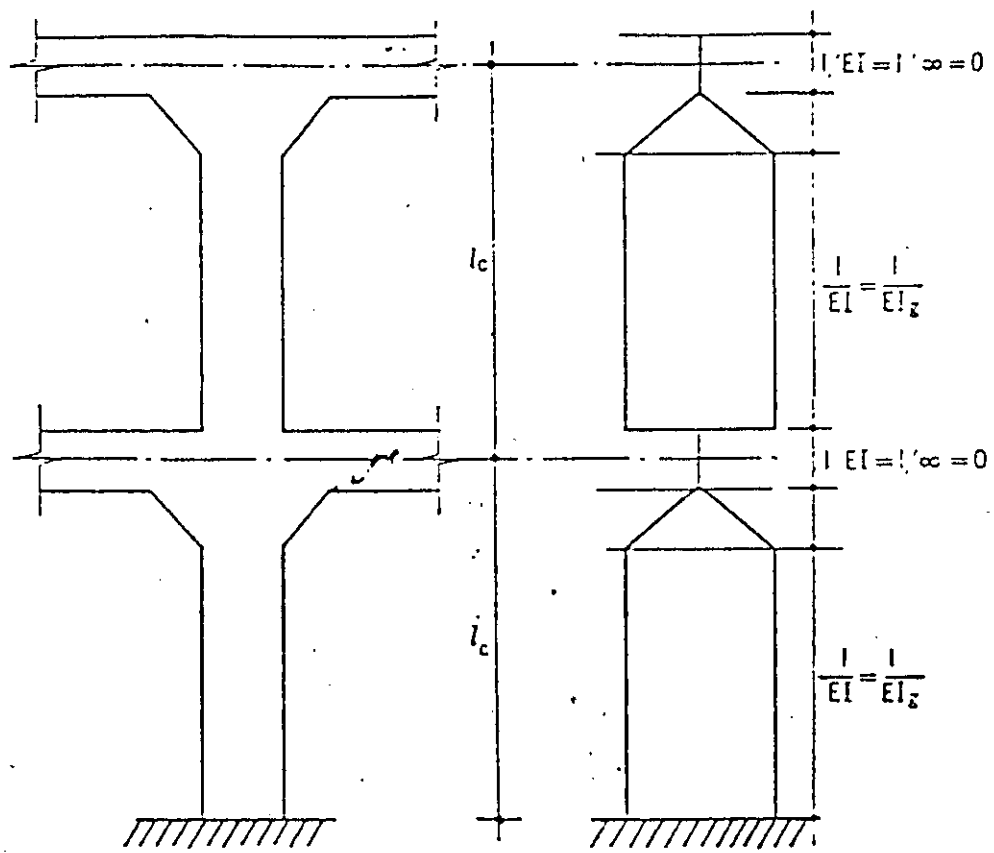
Cálculo de la rigidez de la viga equivalente en sistemas de piso con vigas
